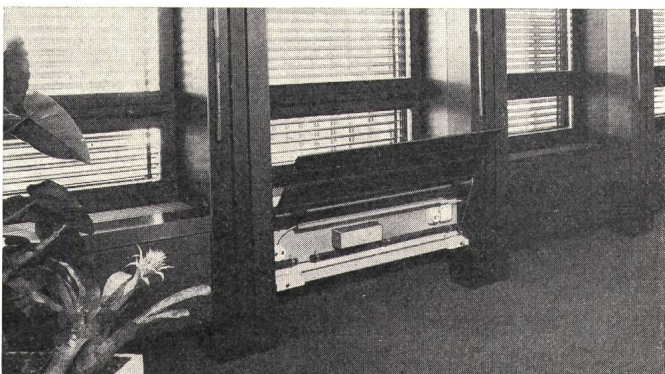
Ein in einem Verwaltungsgebäude in die Fensterkonstruktion eingebauter Brüstungskanal
